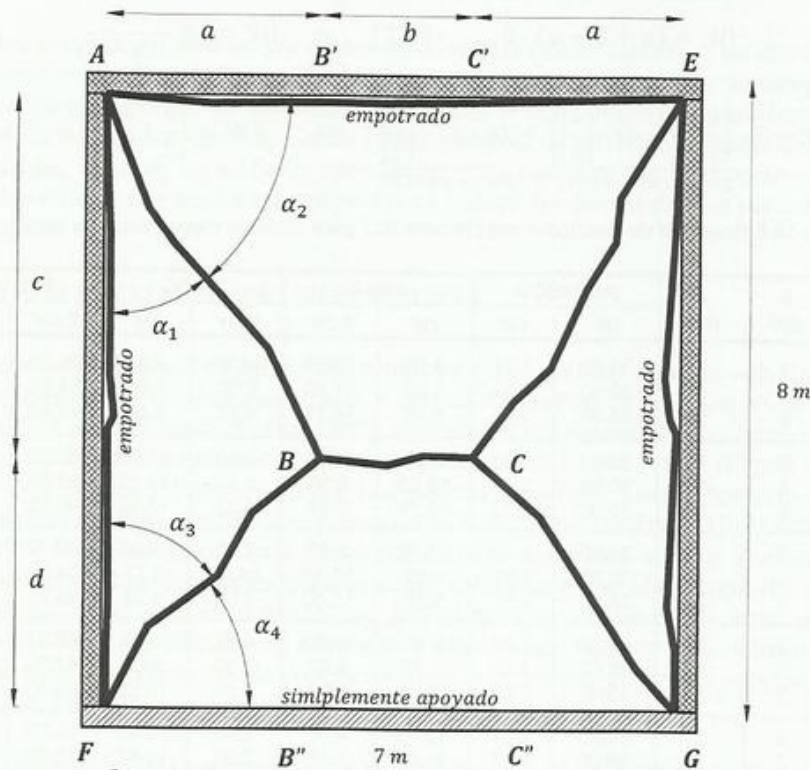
Mecanismo de colapso posible de una losa con refuerzo en dos direcciones. Ejemplo 16.7
